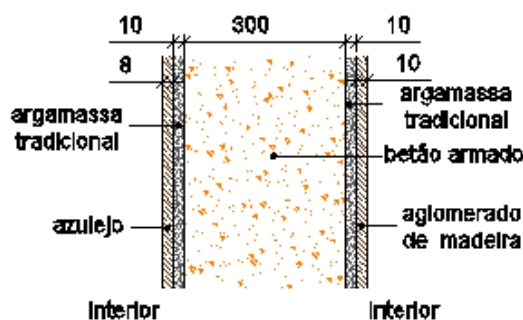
Pormenor das paredes da envolvente interior – PI3
